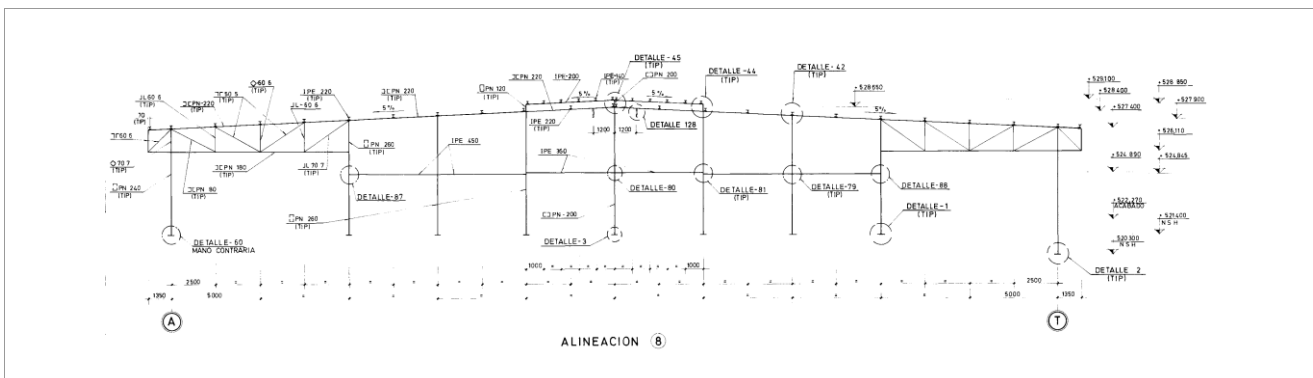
Estructura metálica – Pórtico en alineación 8
